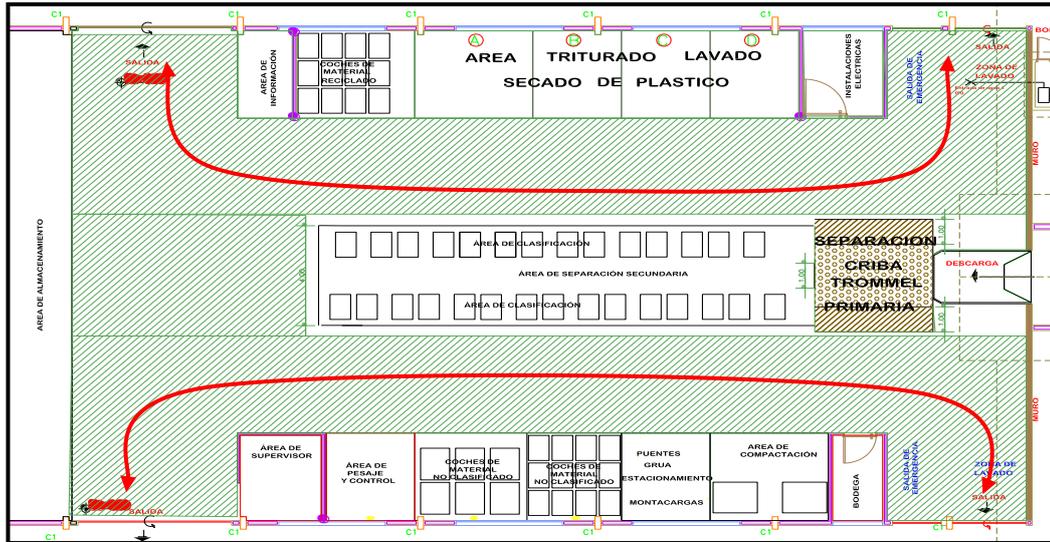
Vista arquitectónica de áreas de movimiento y salidas en la planta de reciclaje
